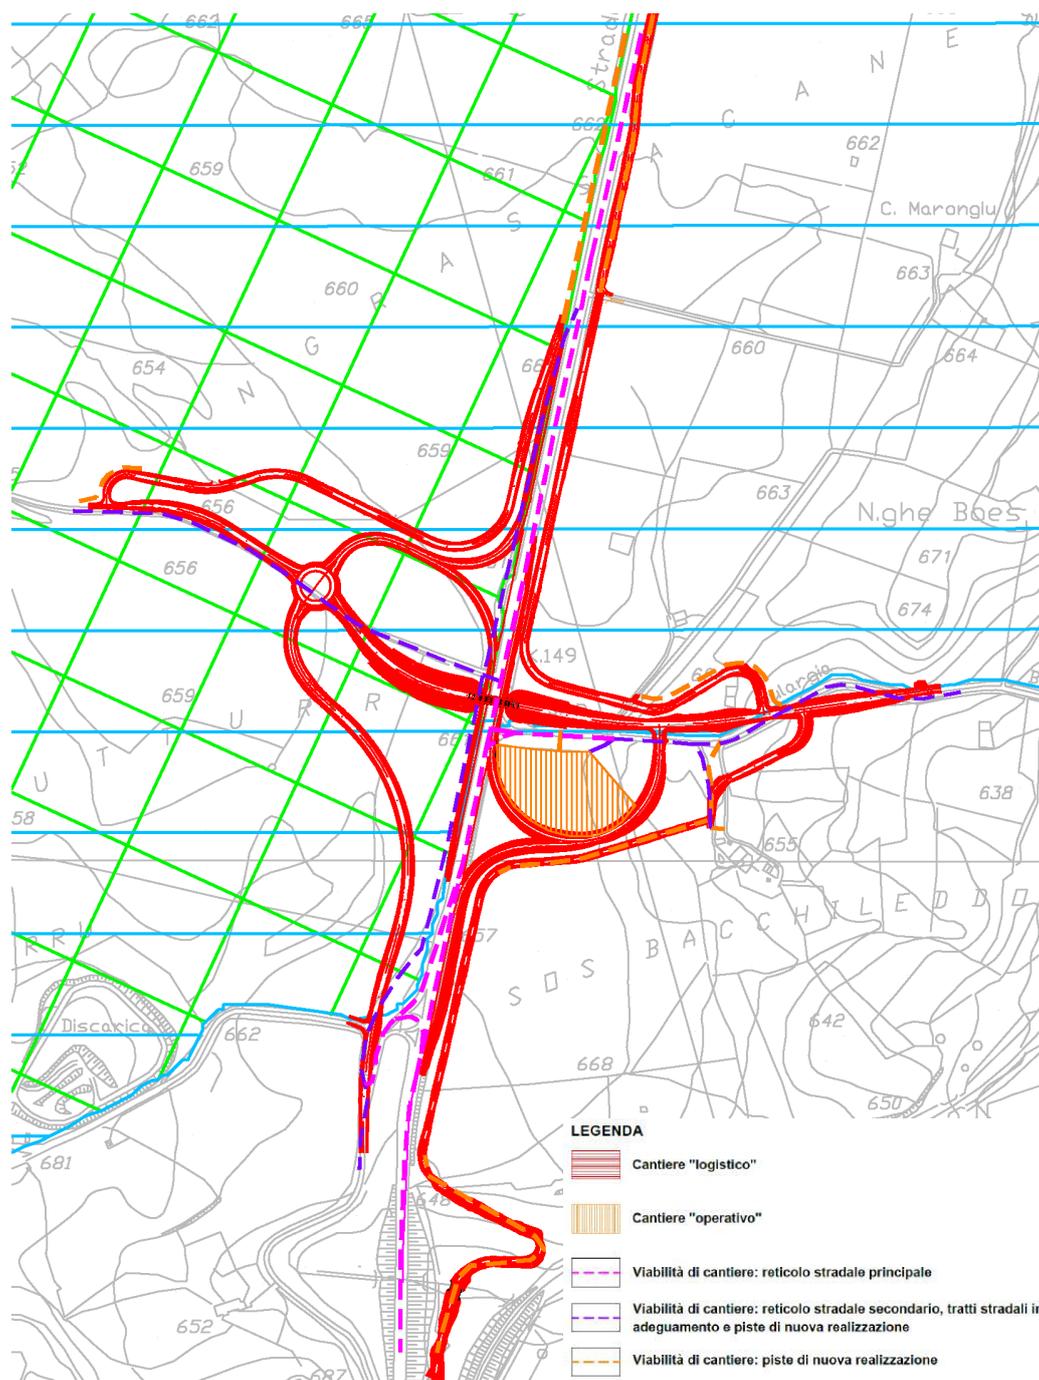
Soluzione P.D. – Aree di cantiere e viabilità di servizio
